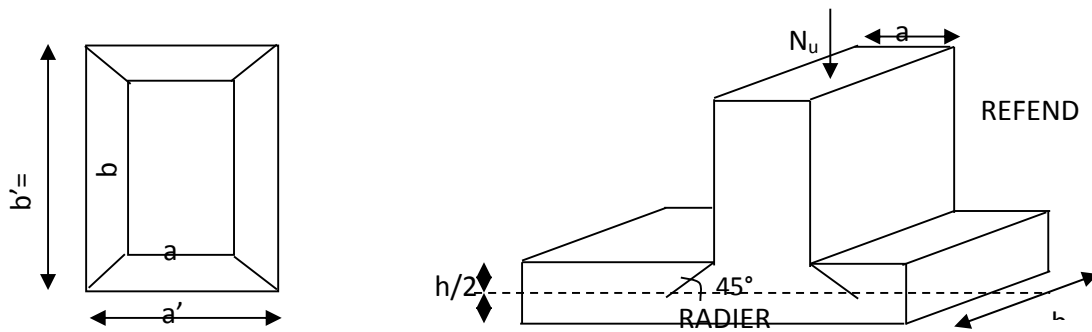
Périmètre utile des voiles et des poteaux
